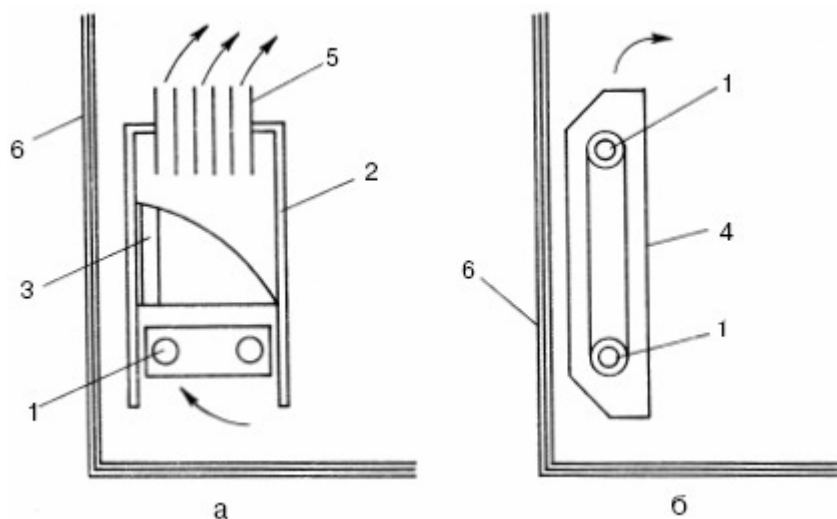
Конвекторы: а – с кожухом; б – без кожуха; нагревательный элемент; 2 – кожух; 3 – воздушный клапан; 4 – оребренные трубы; 5 – решетка; 6 – стена
